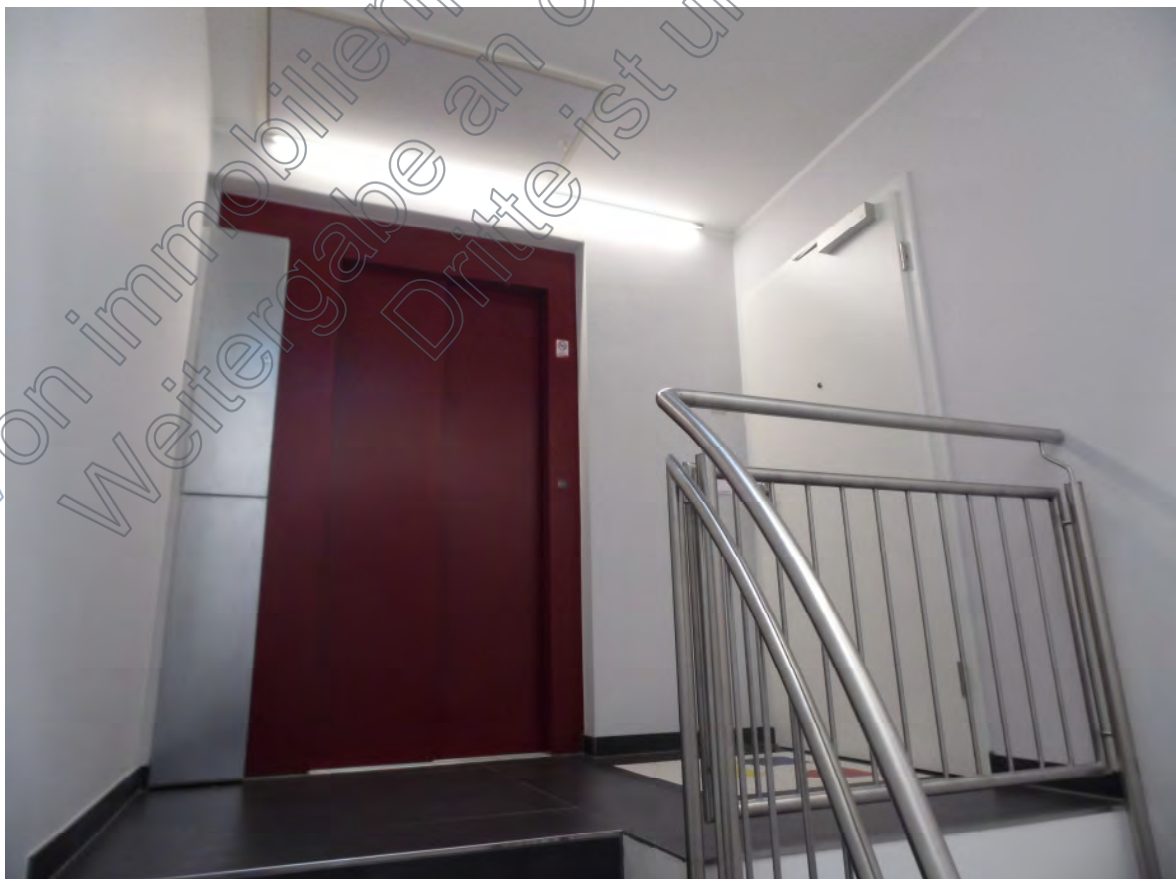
Ausschnitt – Austritt Treppe Richtung Fahrstuhl und mit geschlossener Wohnungseingangstür zur WHG 5
